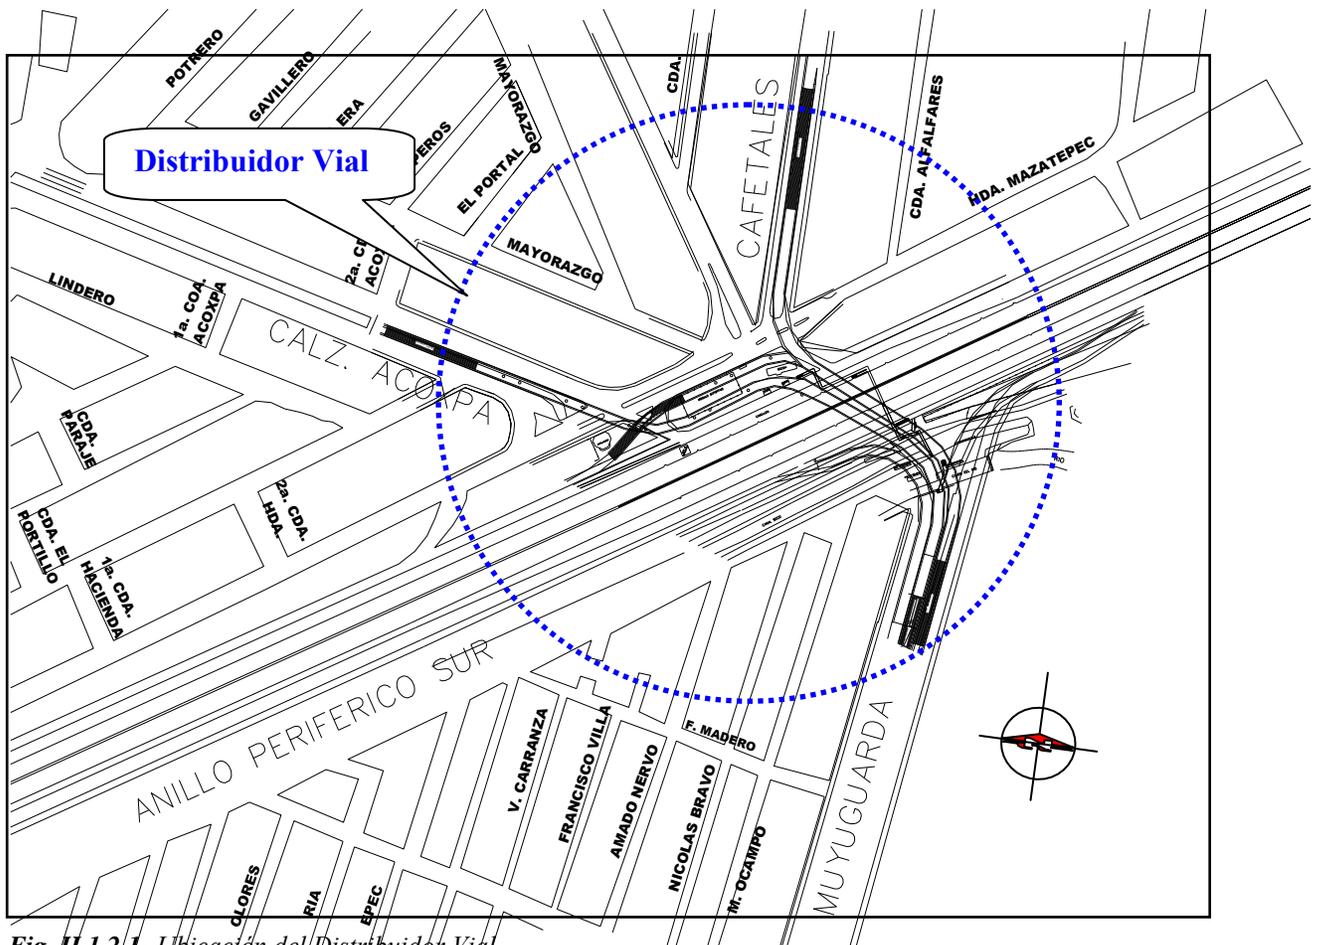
Ubicación del Distribuidor Vial.
